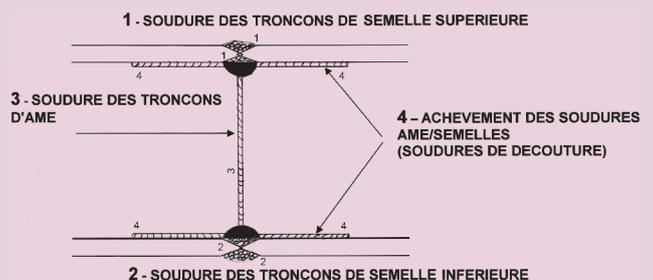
Phasage de mise en œuvre des soudures d'assemblage bout à bout des poutres d'un bipoutre (les étapes 1 et 2 peuvent être inversées)
